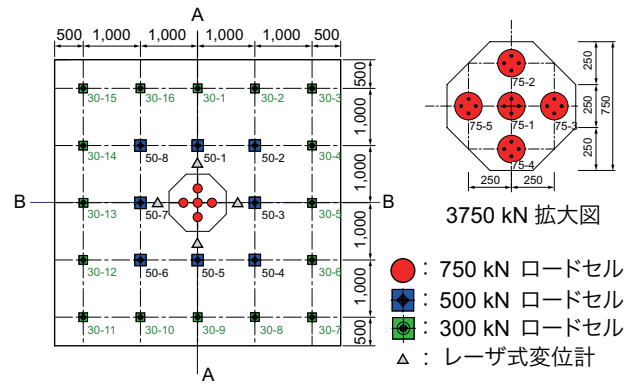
伝達衝撃力測定用ロードセル配置図 (平面図)
